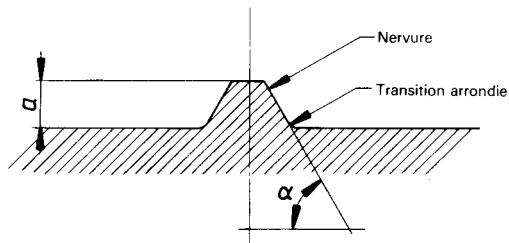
Inclinaison du flanc de nervure, α , et hauteur de nervure, a — Coupe A-A de la figure 1
